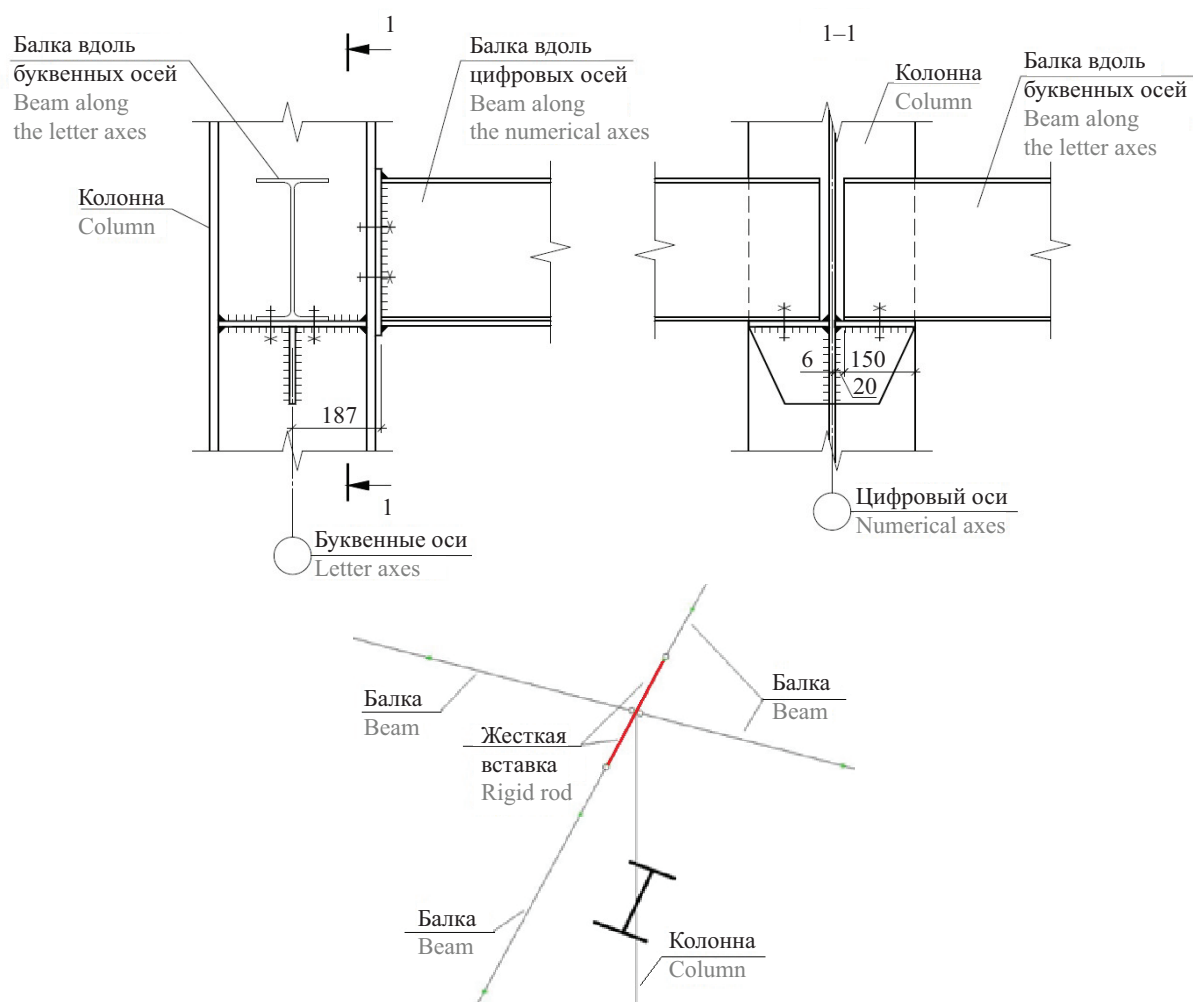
Фрагмент расчетной модели в месте опирания балок на колонну
